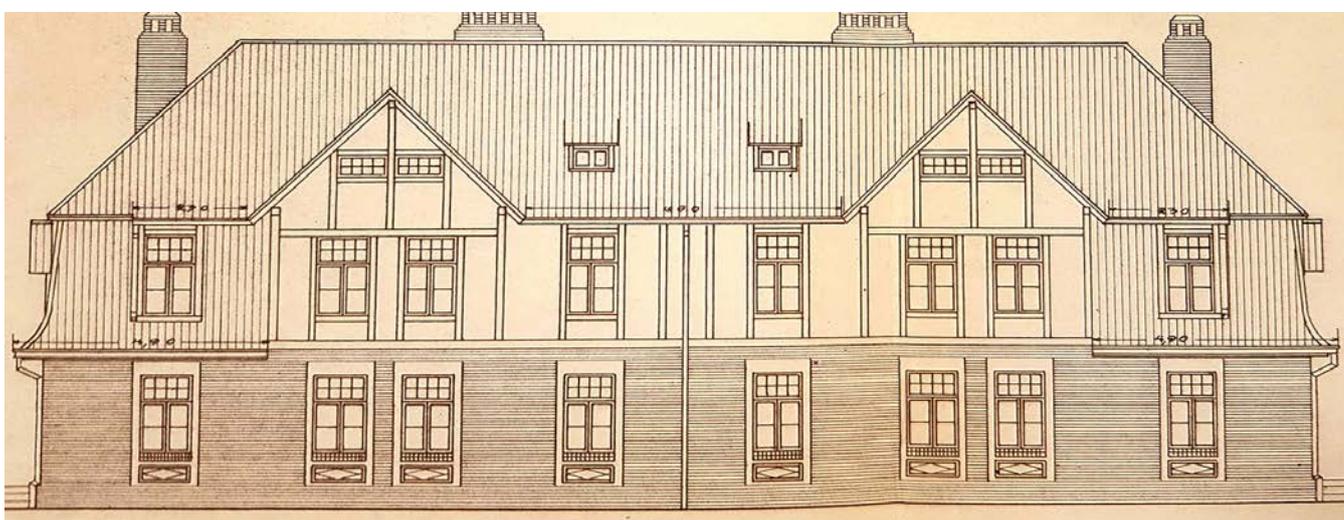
Loewestraße 3 - Haustyp C10 - Historische Zeichnung von 1913
